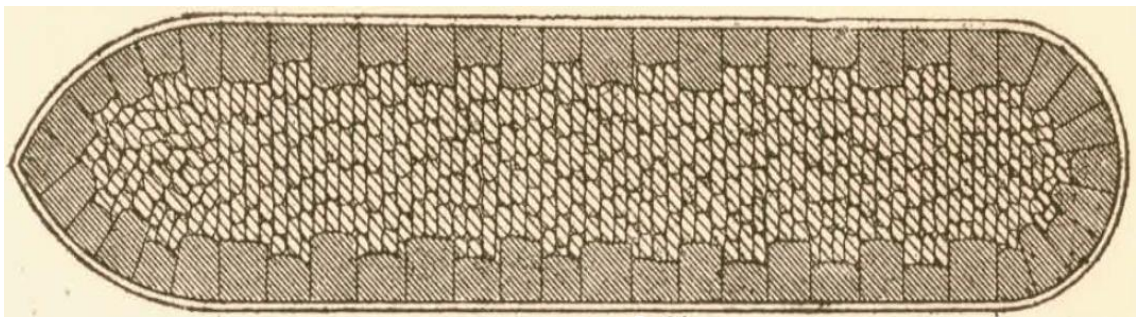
Corte típico en planta de un pilar con dos materiales distintos, un relleno confinado por una capa de mampostería.
